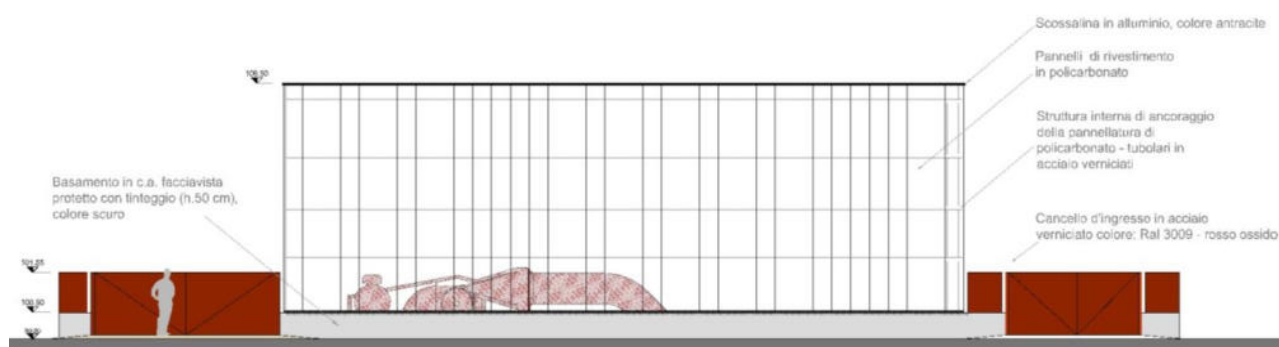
PROSPETTO NORD DELLA CENTRALINA IDROELETTRICA
